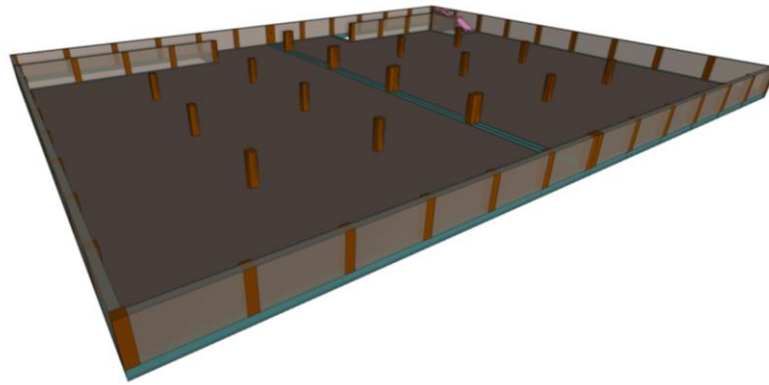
Planta rampa a -0.0 m sobre la rasante.
